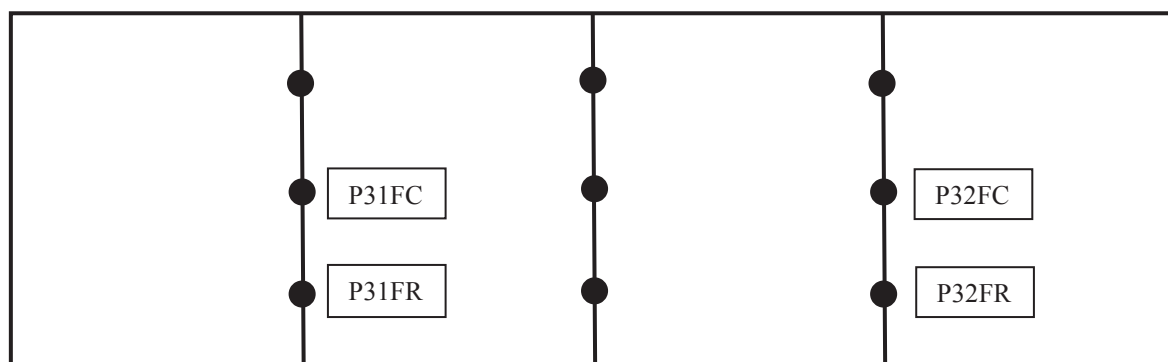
Plan de disposition géométrique des fûts du pont 2
